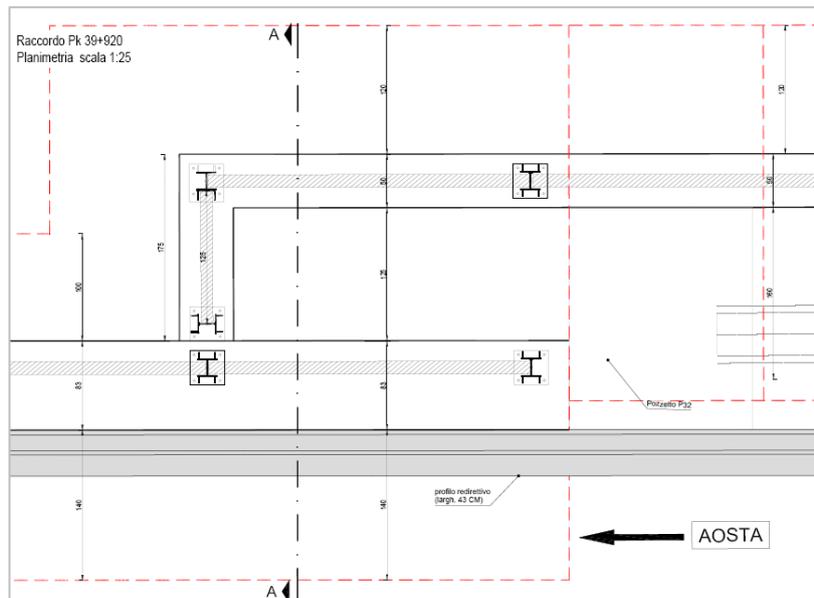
/3 Tratto di raccordo fondazioni tipo 1-tipo 2 alla progressiva 39+920 – Pianta
